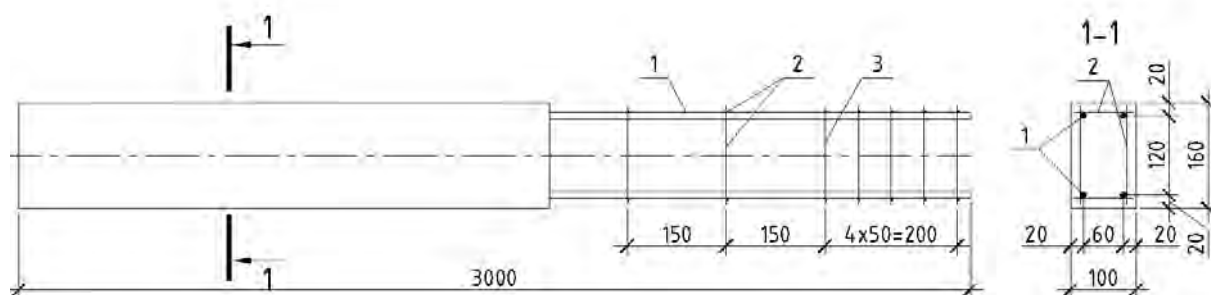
Конструкция опытных образцов (колонн): 1 – рабочая арматура; 2 – поперечные стержни; 3 – сетки косвенного армирования
